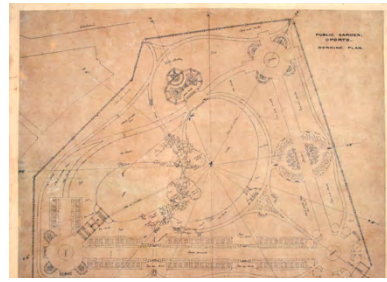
Projeto, não executado, de Edward Lamb, Planta 1856 - (AHMP).
